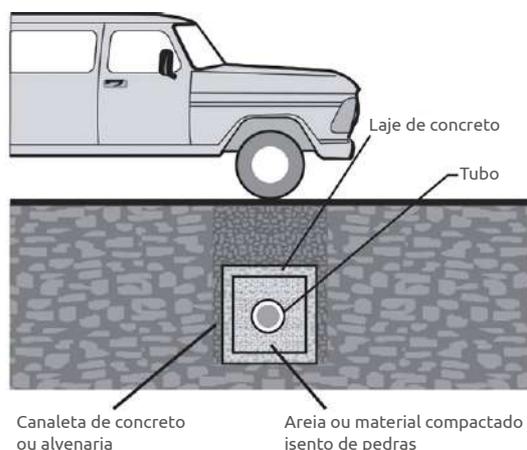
Detalhe de Proteção Adicional para Tubulações Sob Carga
